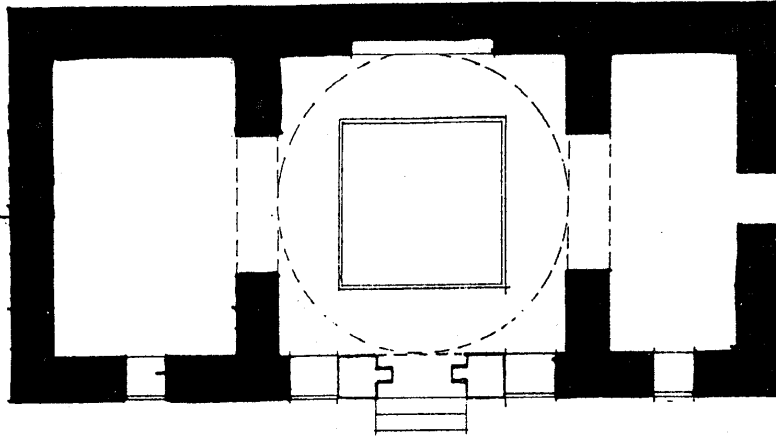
مسقط أفقي للمدفن الملحق بجامع سليمان باشا
